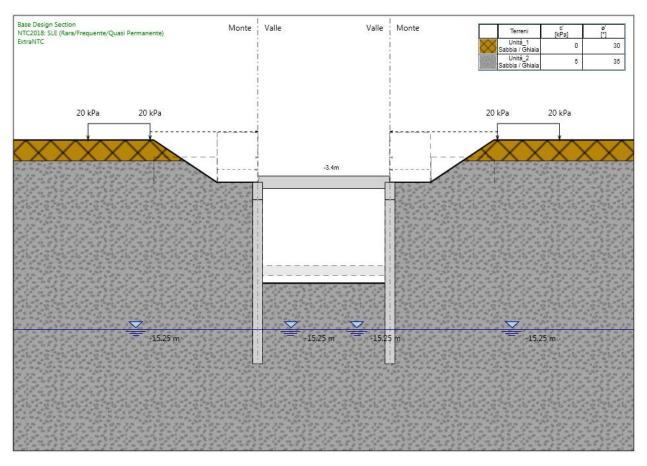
Fase 10: applicazione extra-scavo da NTC18
